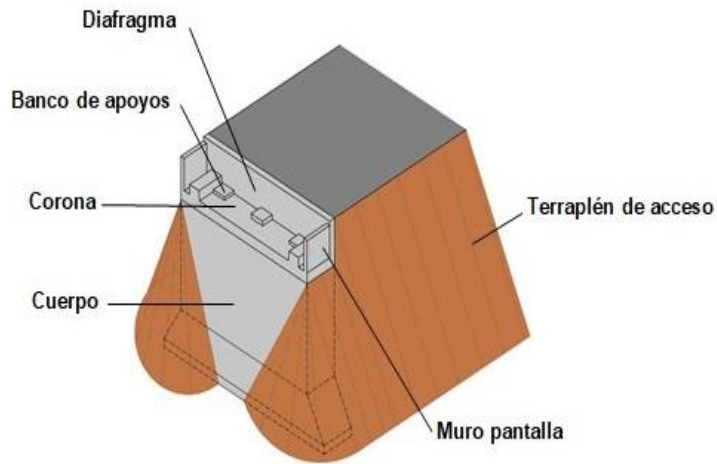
Elementos de un estribo enterrado (Manual para Inspección de Puentes, 2018).
